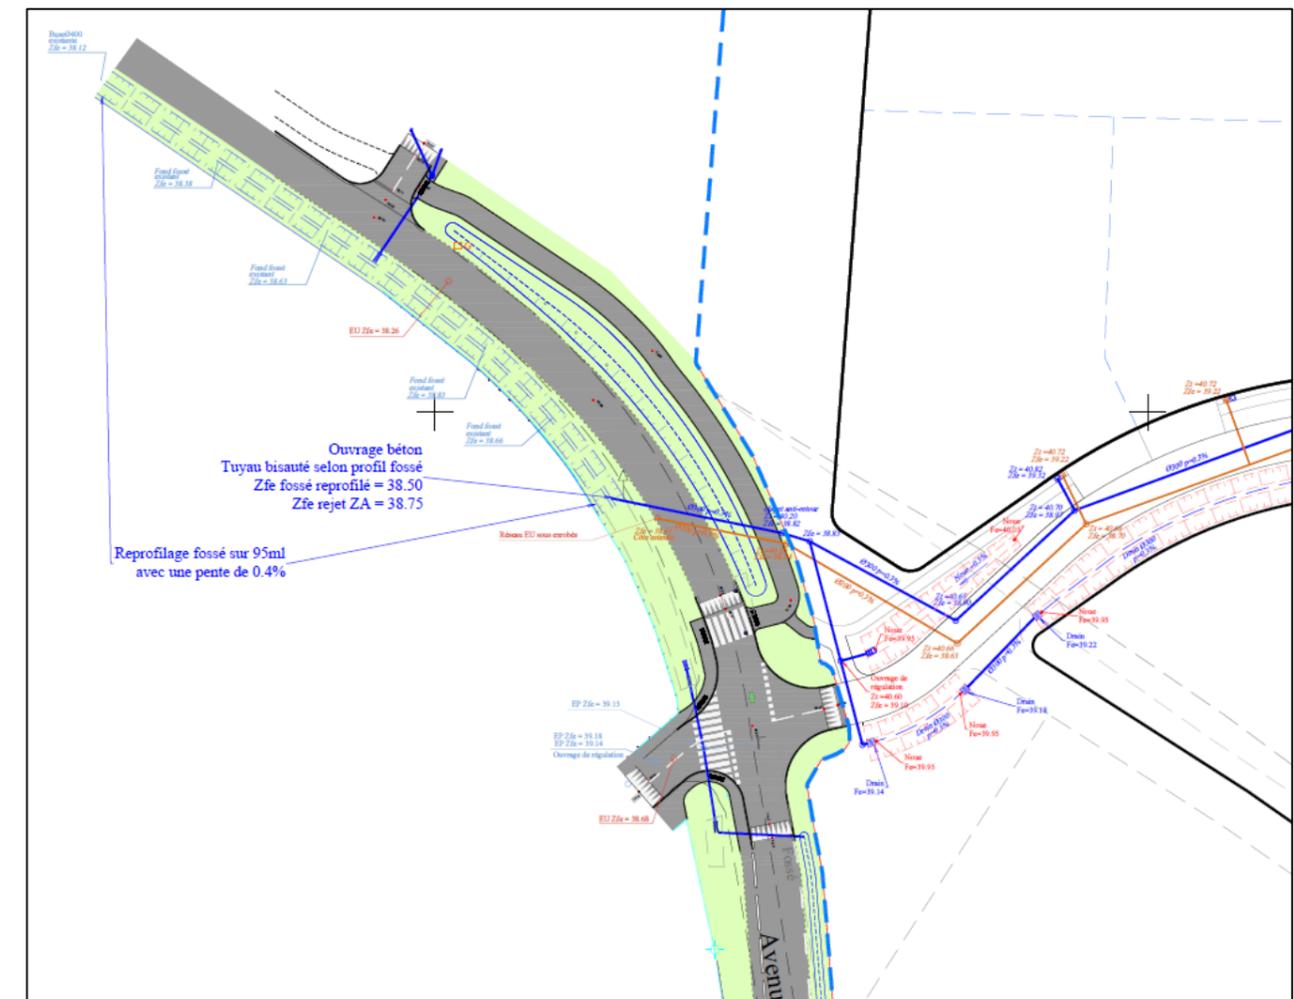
Plan de raccordement du réseau d'assainissement sur le domaine public
